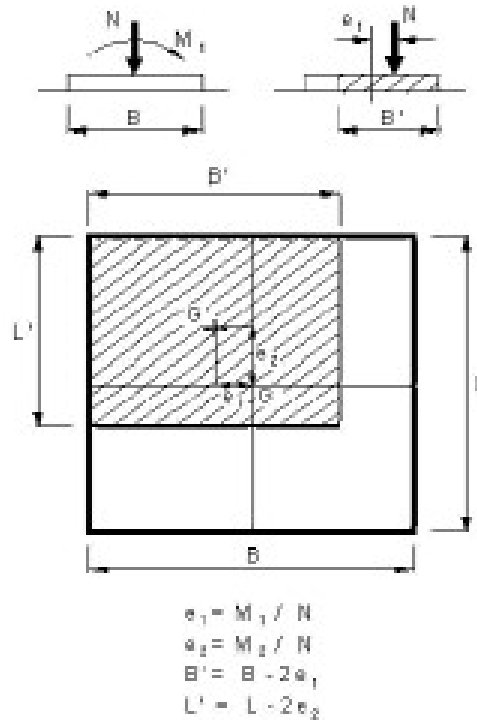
Fondazione efficace equivalente nel caso di fondazione rettangolare
